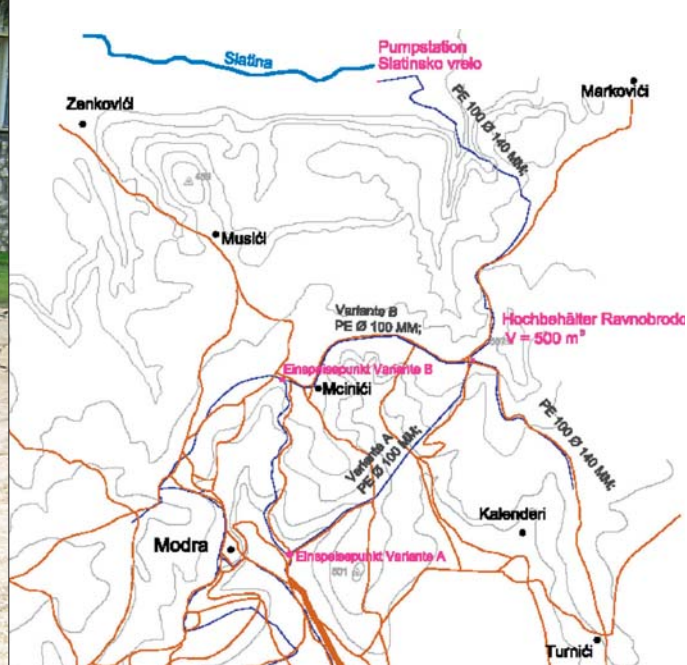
Übersichtslageplan Trinkwasserversorgung Modra
